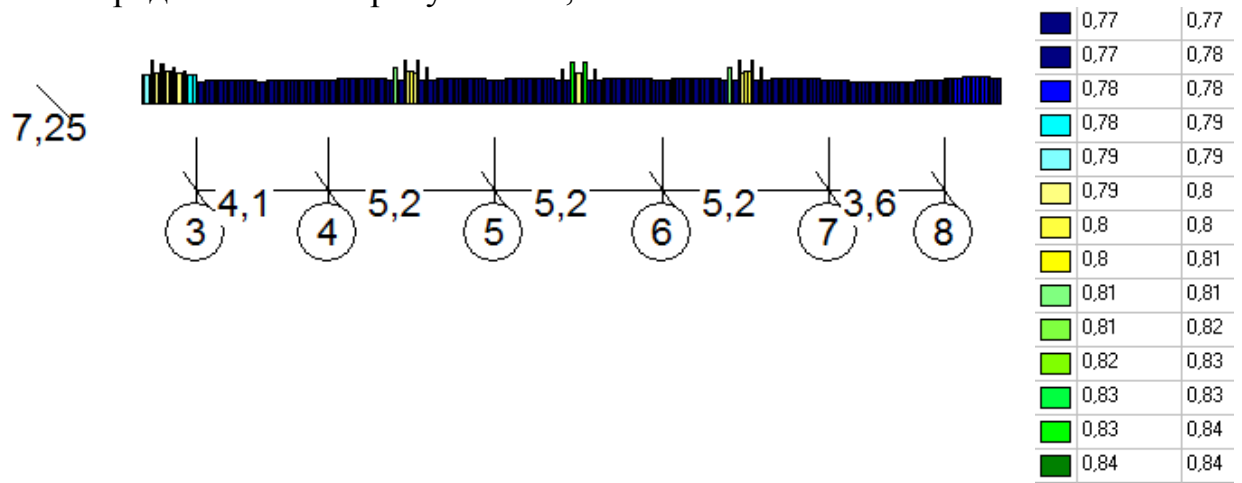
Эпюра нижней арматуры второстепенной балки
